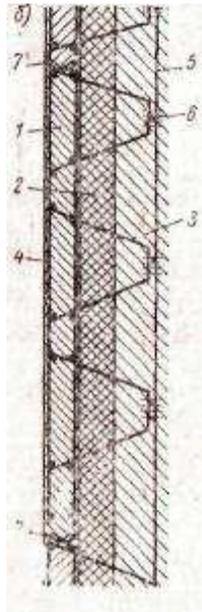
Конструкция гидроизоляции из сборных элементов (к п. 3.37)
